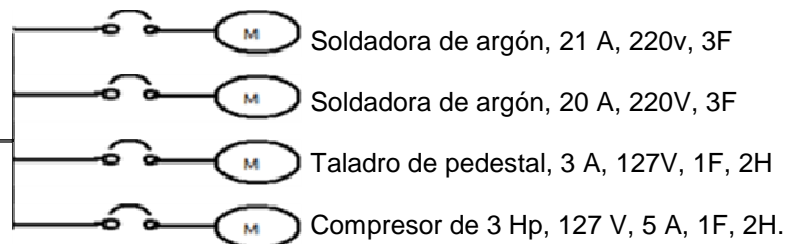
Arreglo de alimentación en Primer y segundo piso.
